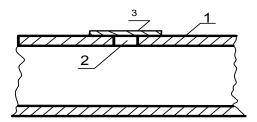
Пробоотборное отверстие: I – газоход; 2 – отверстие; 3 – накладка
